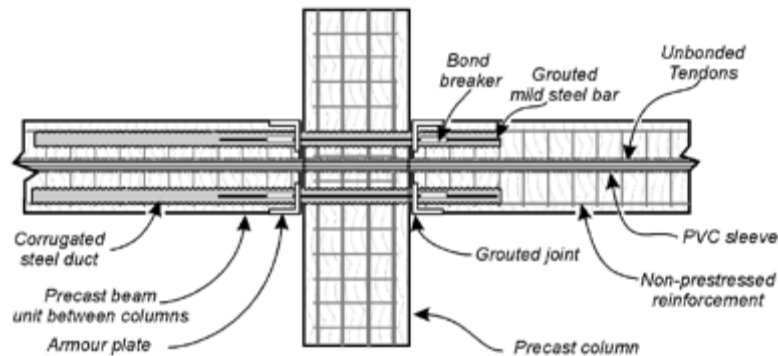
Unión híbrida de vigas prefabricadas postensadas entre columnas (Blandón & Rave, 2016).
